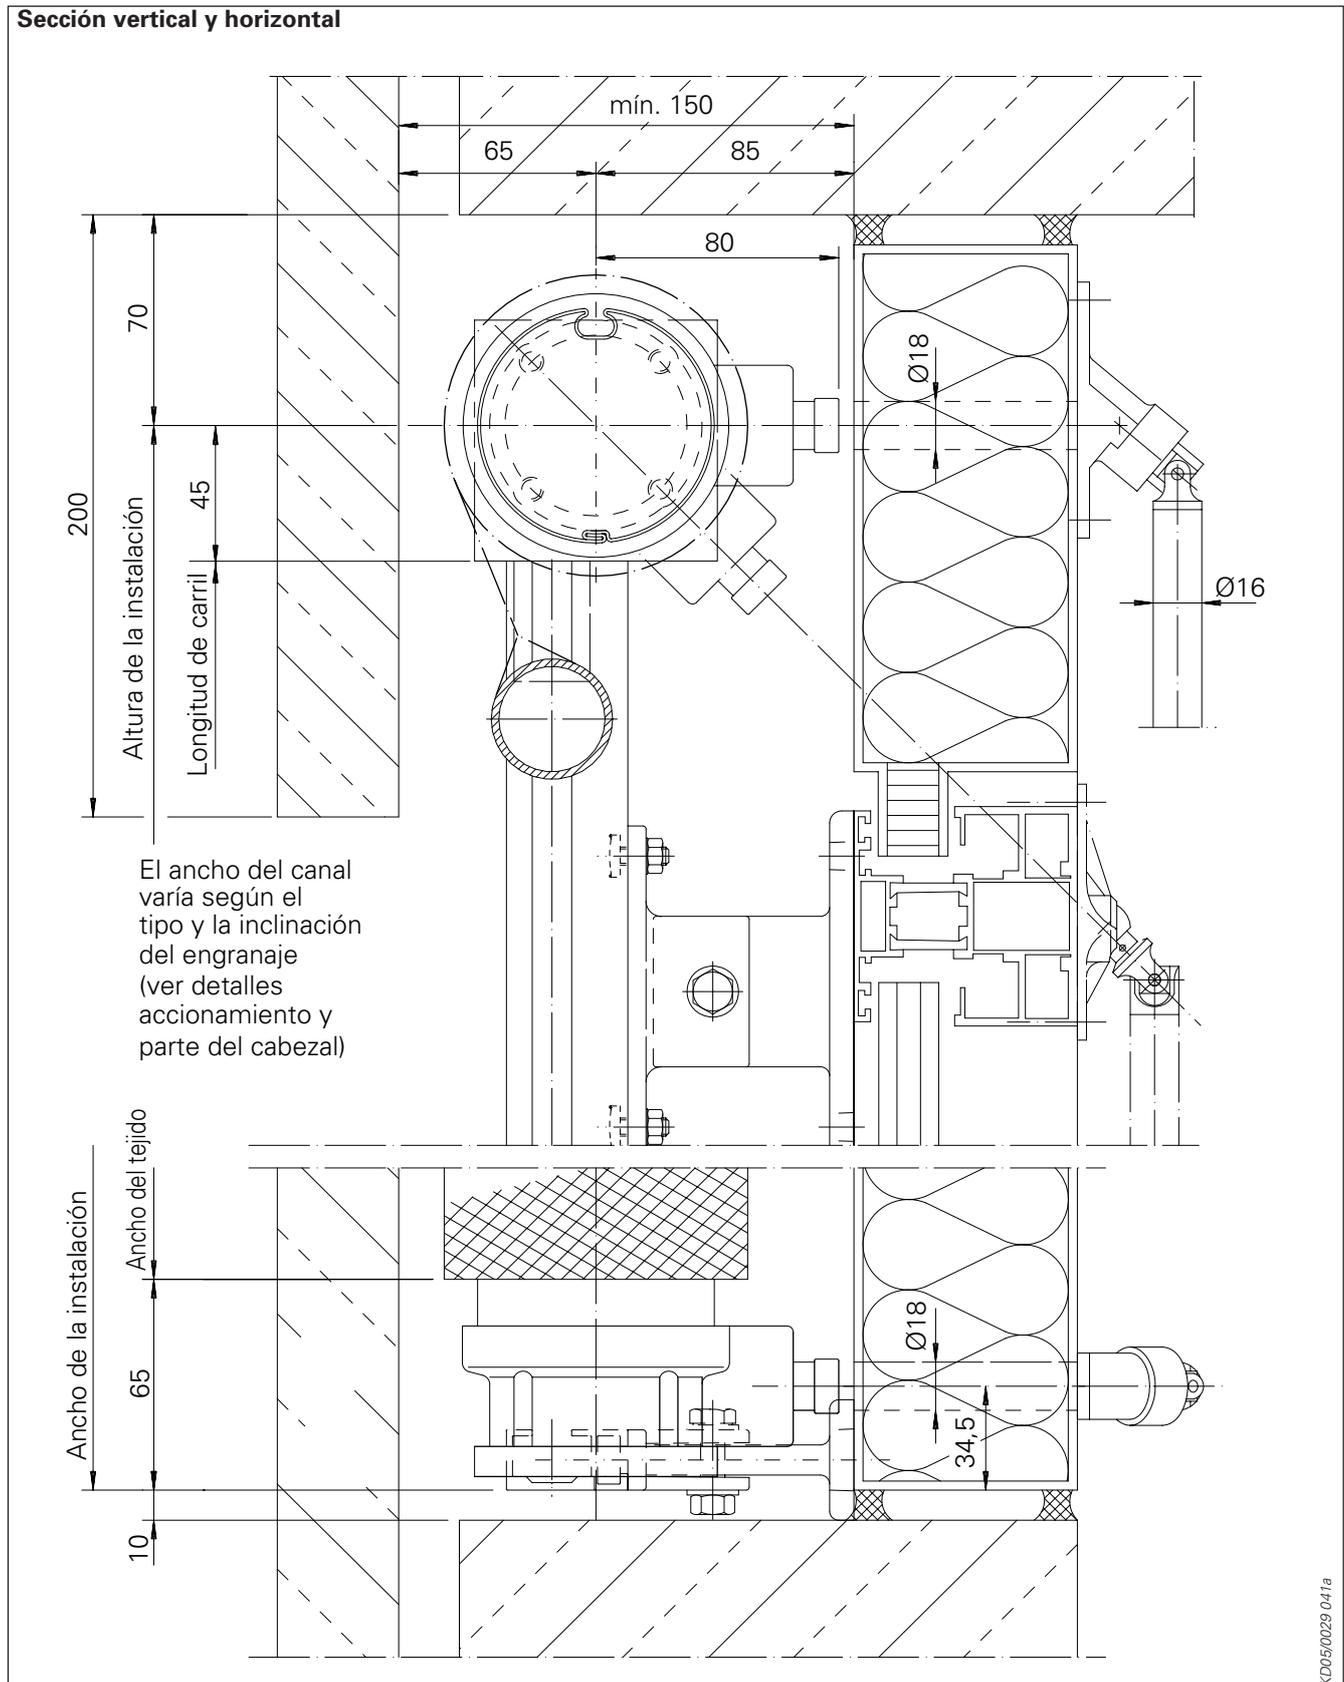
Sección horizontal toldo para fachadas modelo 201 K en canal in situ, enrollamiento a la derecha
